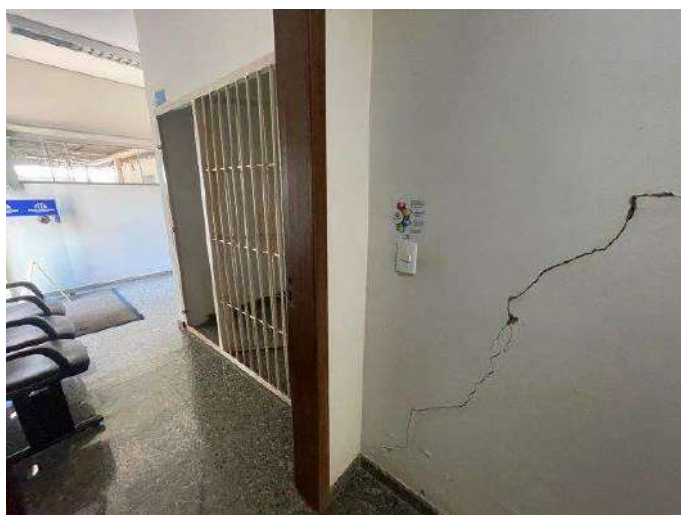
Rachadura na parede do Lavabo, próximo a Cella da Espera Policial no Pav. Térreo
